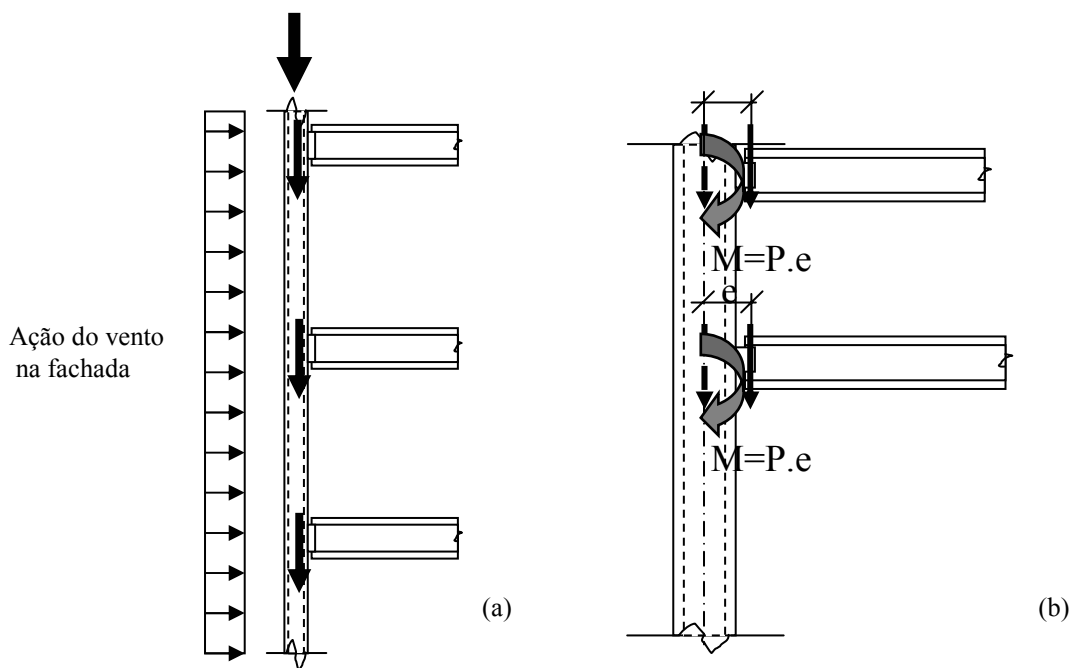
(a) Ação de forças horizontais e verticais em pilar de fachada; (b) Efeito de excentricidade em ligações viga-pilar
